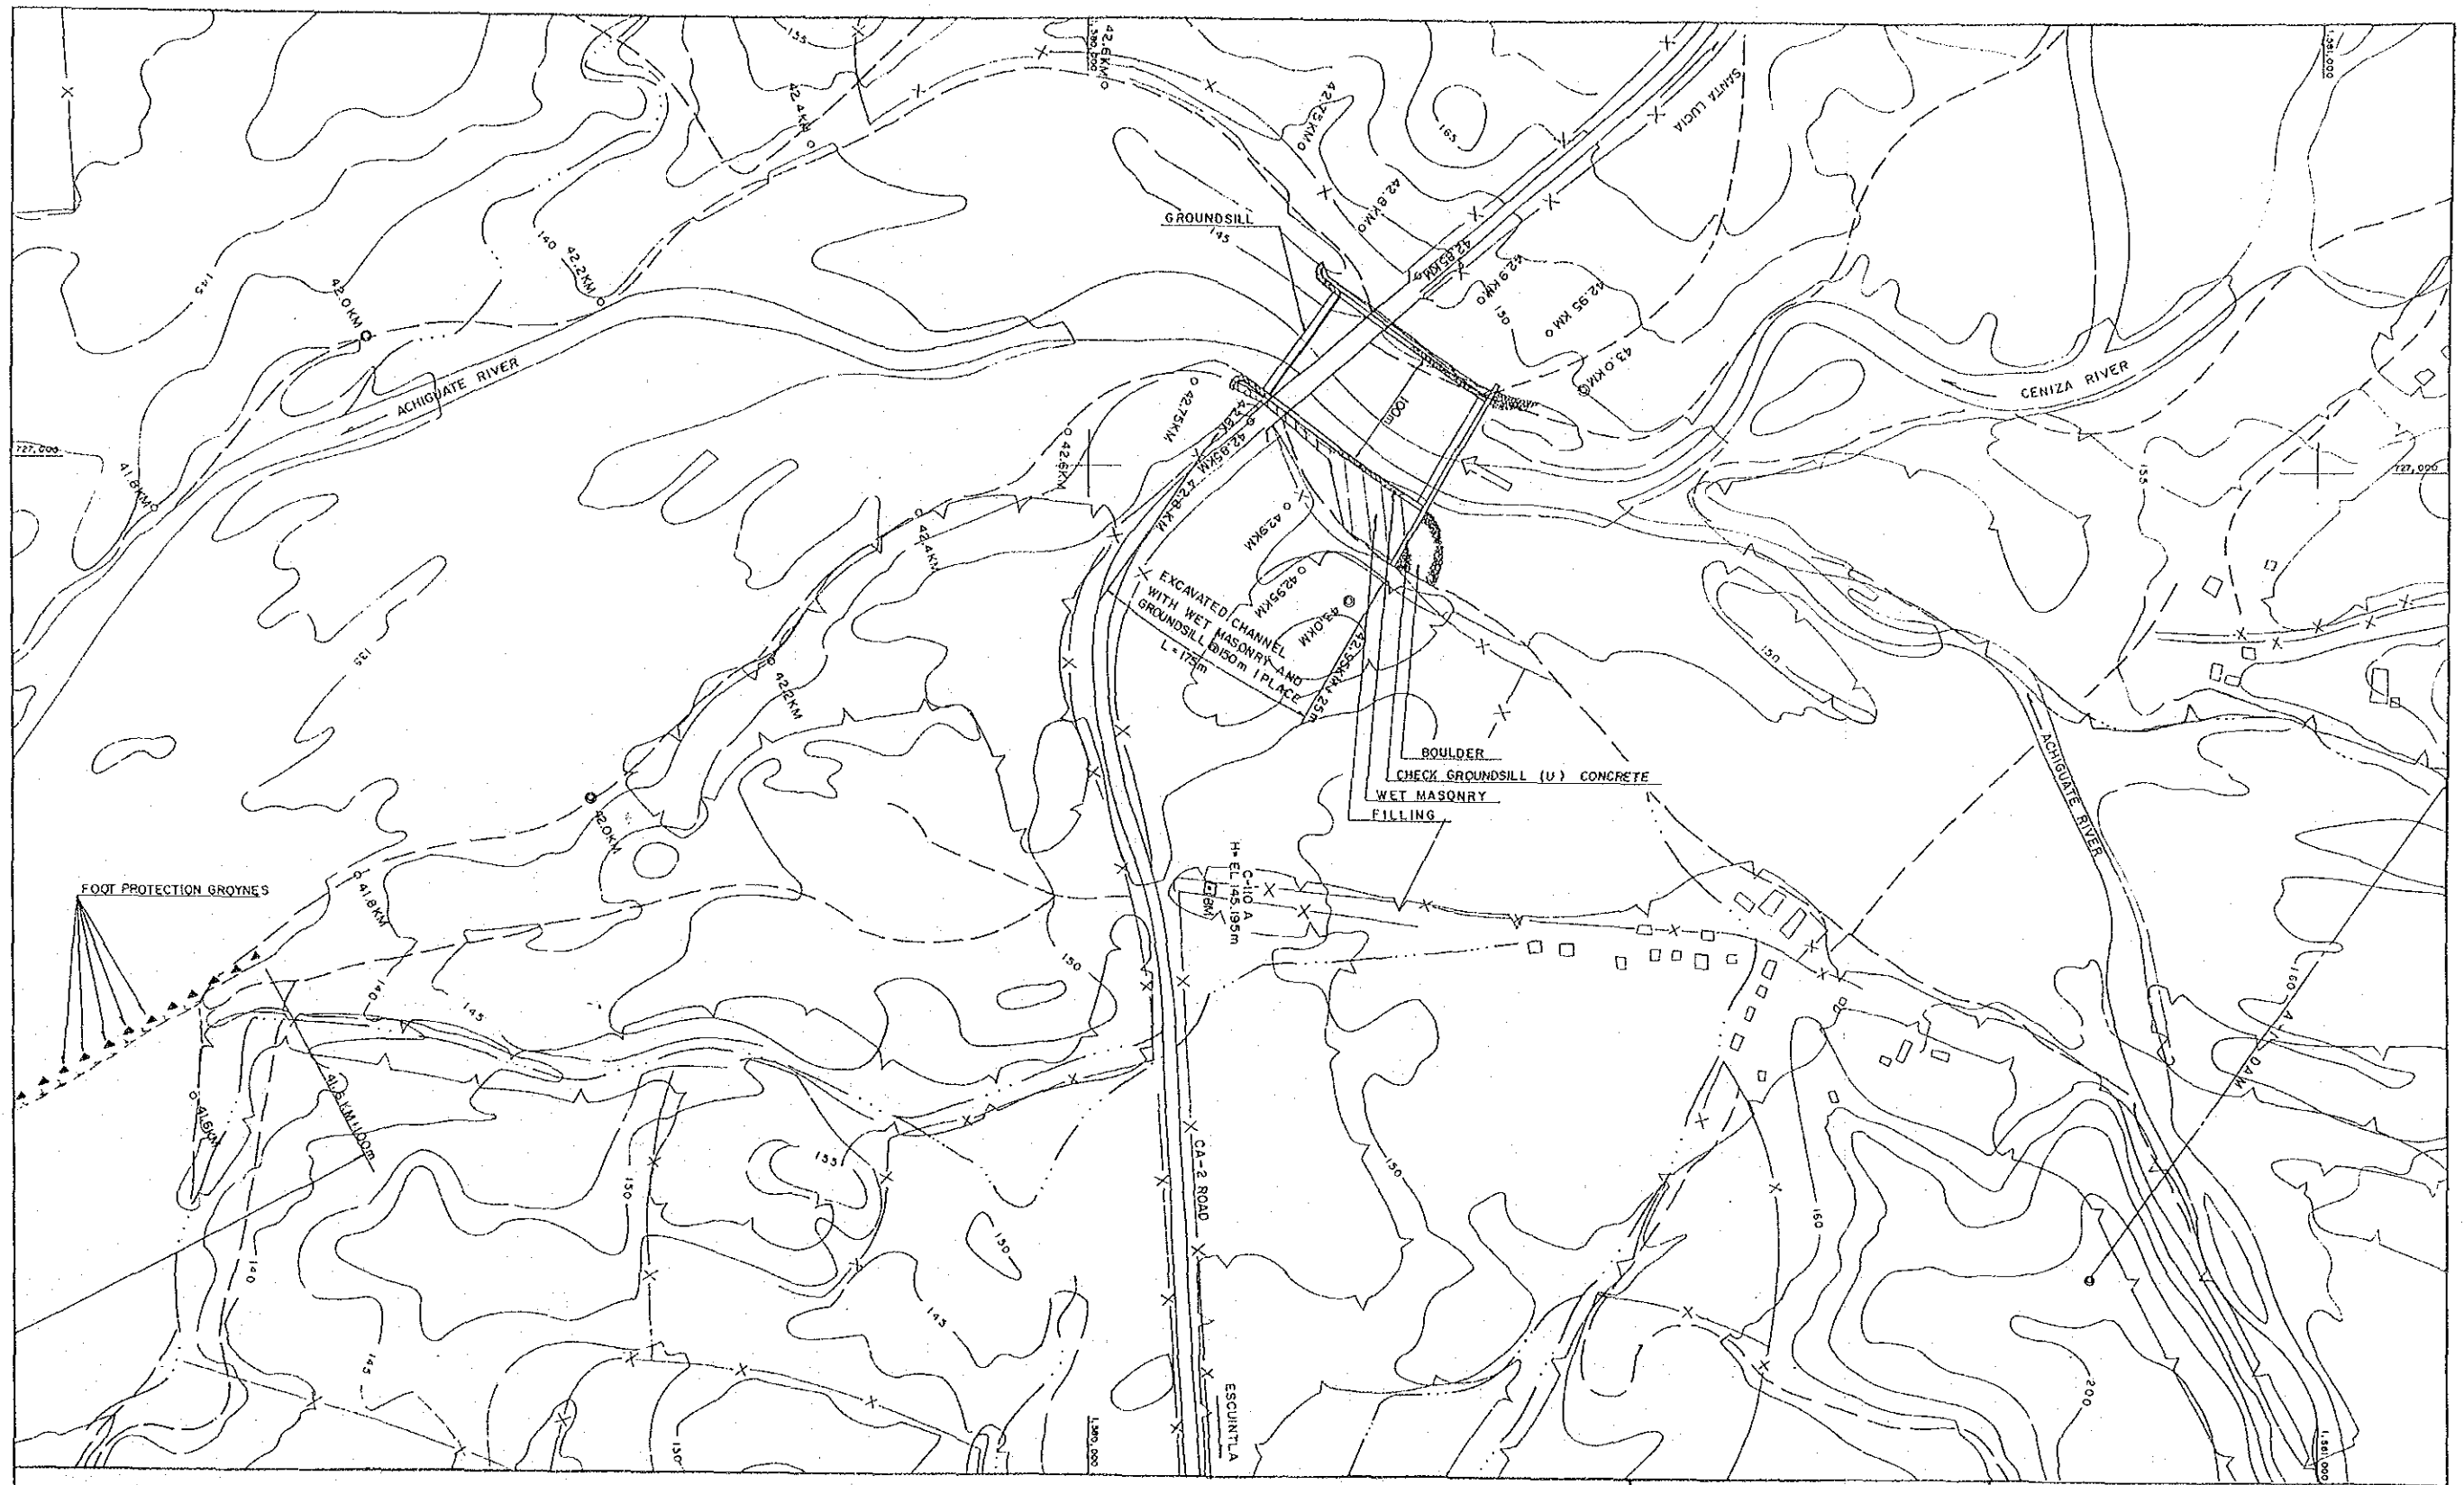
(2/6) PLAN DE MEJORAMIENTO DEL CAUCE (PLAN PROPUESTO) (RIO ACHIGUATE)
